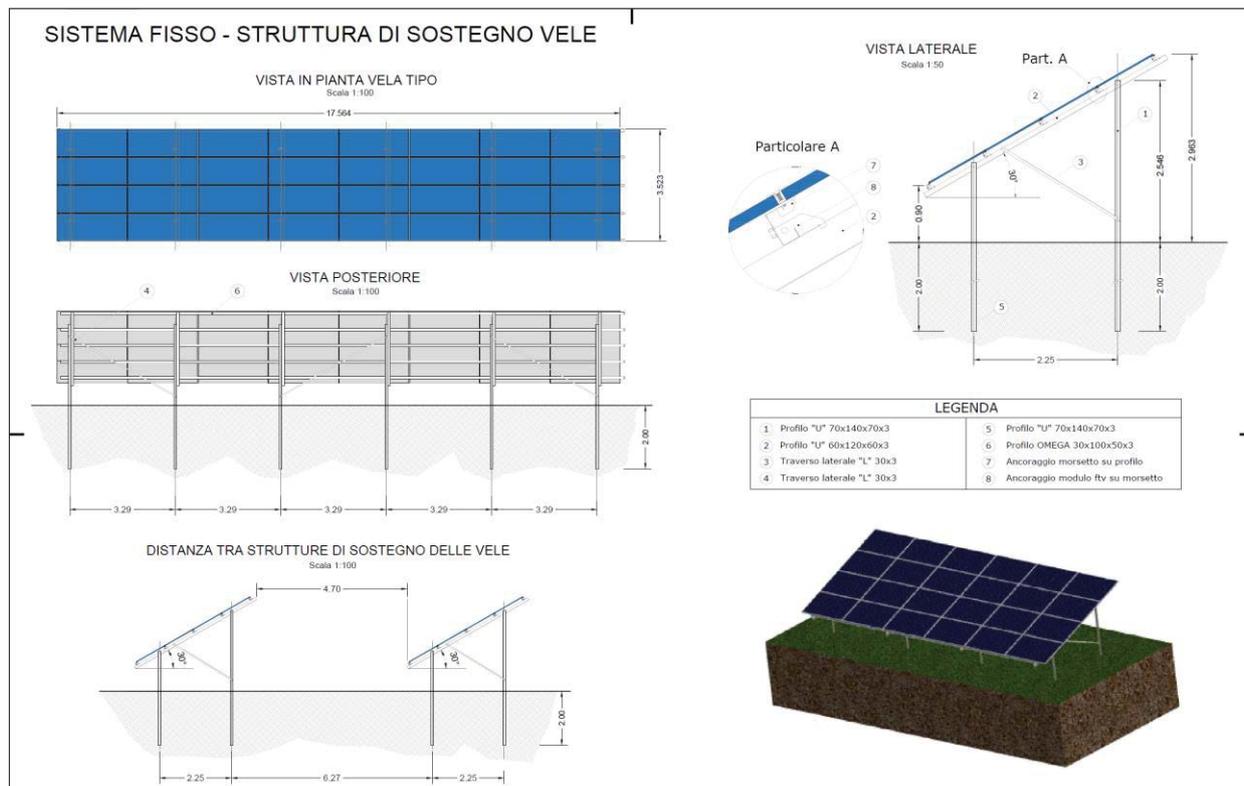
Strutture di sostegno (vista laterale, dall'alto, sketch 3D)
